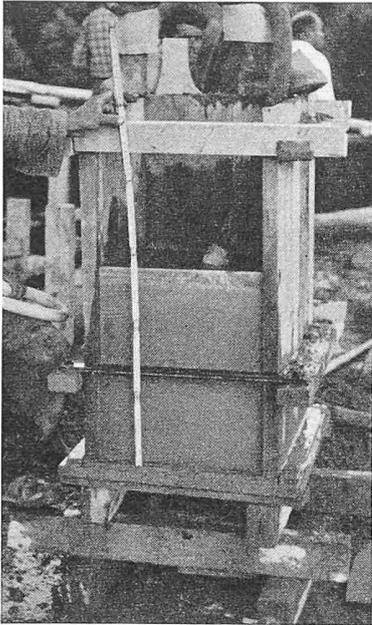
Plexiglaskiste zur Beurteilung der zu erwartenden Betonsichtflächen
